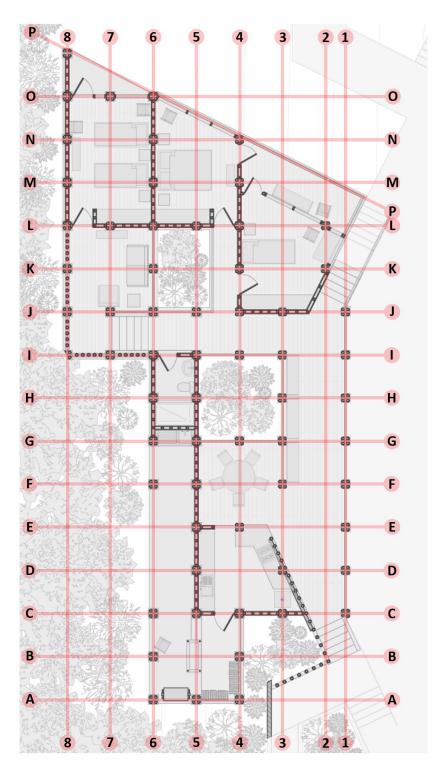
Ejes estructurales propuestos Fuente: Elaboración propia
